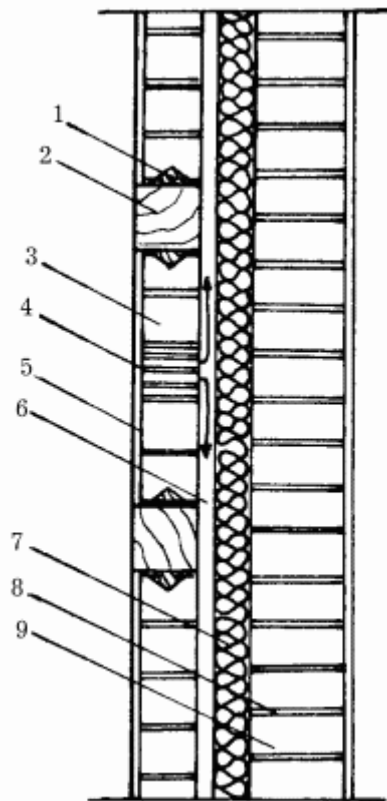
Конструкция стен: 1 – трехгранный брус; 2 – дуб; 3 – кирпичная кладка; 4 – вентиляционное отверстие; 5 – штукатурка; 6 – вентиляционный слой; 7 – теплоизоляция; 8 – внутренняя штукатурка; 9 – кладка в обшивке.
